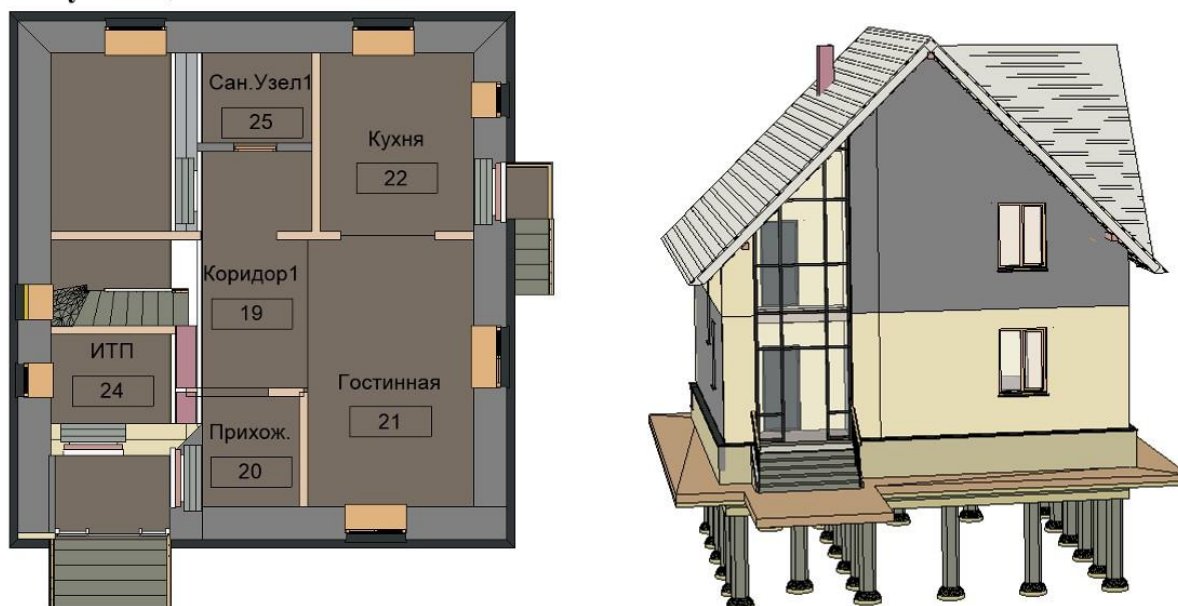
План 1-го этажа и 3D вид малоэтажного жилого здания
